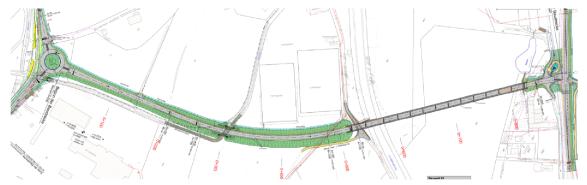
Planauszug StBA Amberg-Sulzbach Lageplan des Planzustandes
